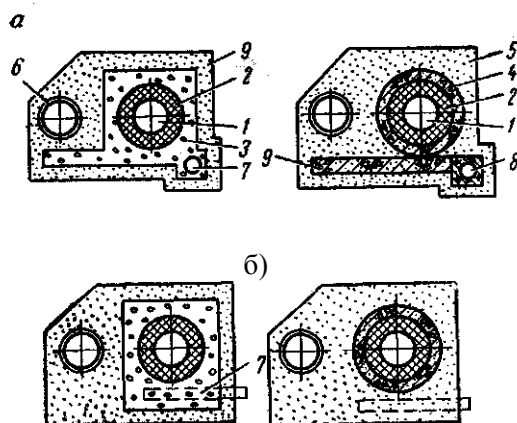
Бесканальная прокладка теплопроводов: а — с продольным дренажем; б — с поперечным дренажем; 1 — труба; 2 — теплоизоляция; 3 — гравийный слой; 4 — пористые скорлупы; 5 — песок; 6 — антикоррозийное покрытие; 7 — дренажная труба; 8 — труба-фильтр; 9 — дренажная плита-
